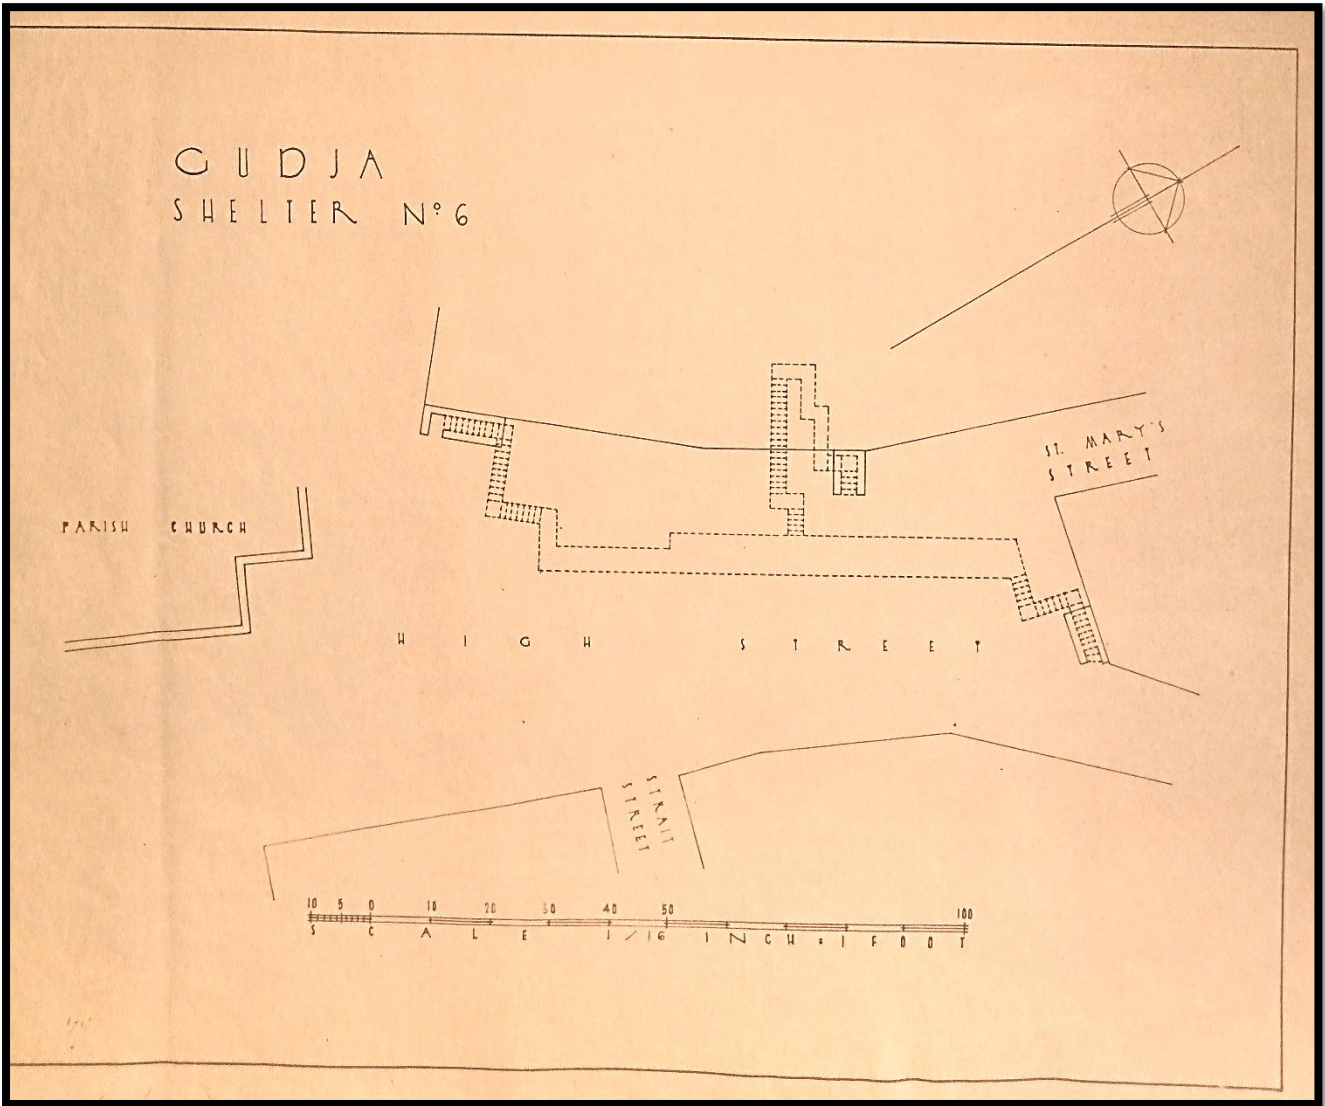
Planta do Abrigo nº6 "Parish Church – High Street – St. Mary's Street."
